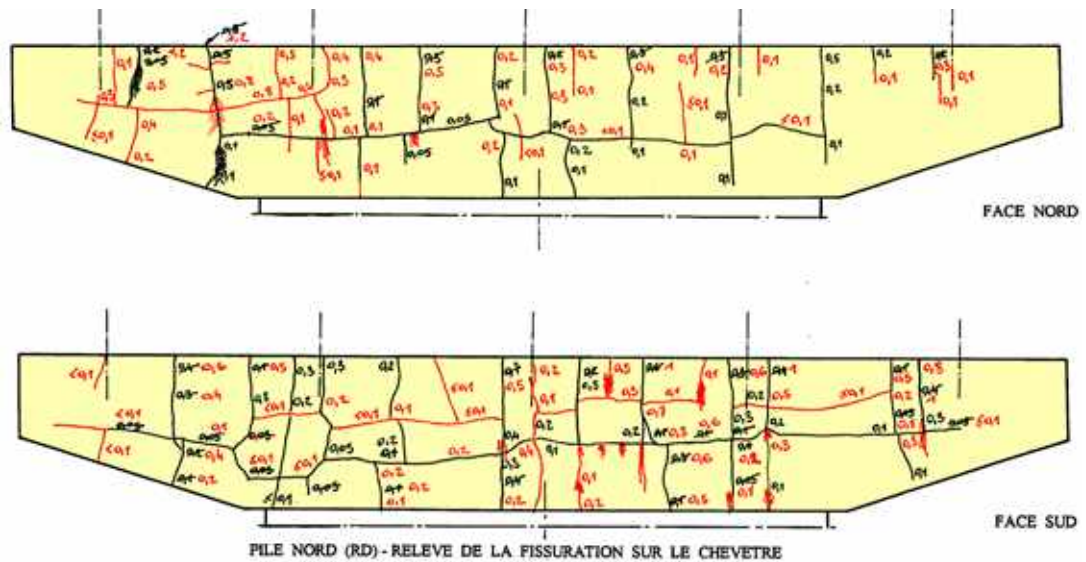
relevé de la fissuration du chevêtre (crédit photo CÉTÉ d'Aix-en-Provence - M. Broquet)
